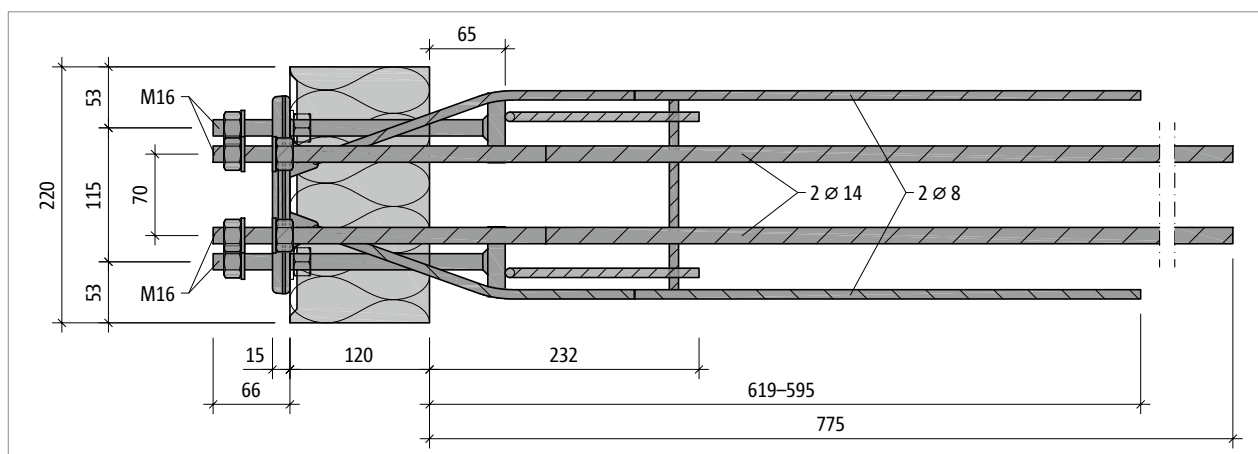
Schöck Isokorb® XT type SK-M1-V1 : vue en plan
